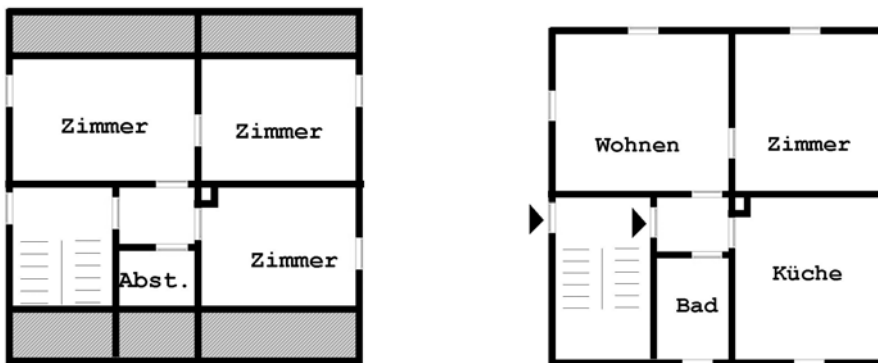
Typischer Grundriss eines Siedlungshauses, auch als Doppelhaus möglich, eigene Skizze ohne Maßstab
